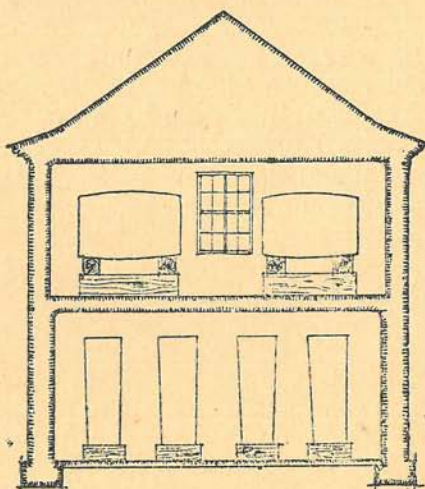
Plan sytuacyjny lokalu fermentacyjnego.
